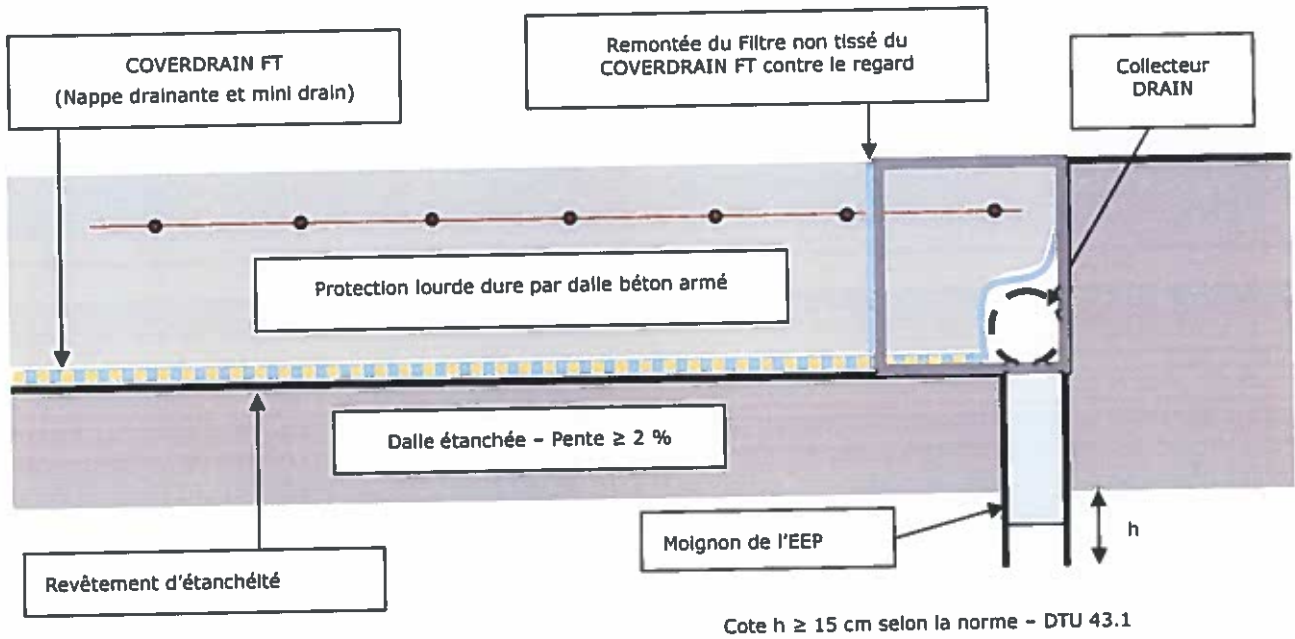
Raccord au droit d'une évacuation d'eau de pluie (EEP) - sous protection lourde dure en dalle béton armée
